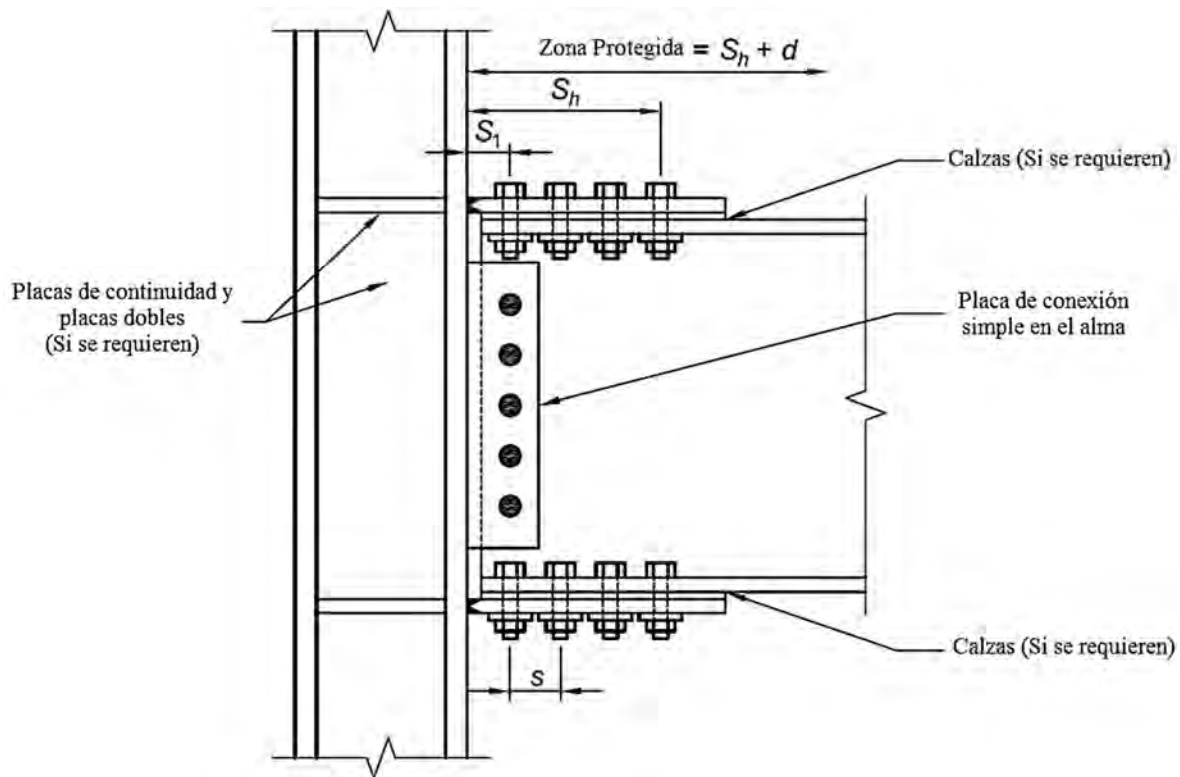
Conexión con placas atornilladas a patines de viga (BFP) (AISC 358-16 2016).
